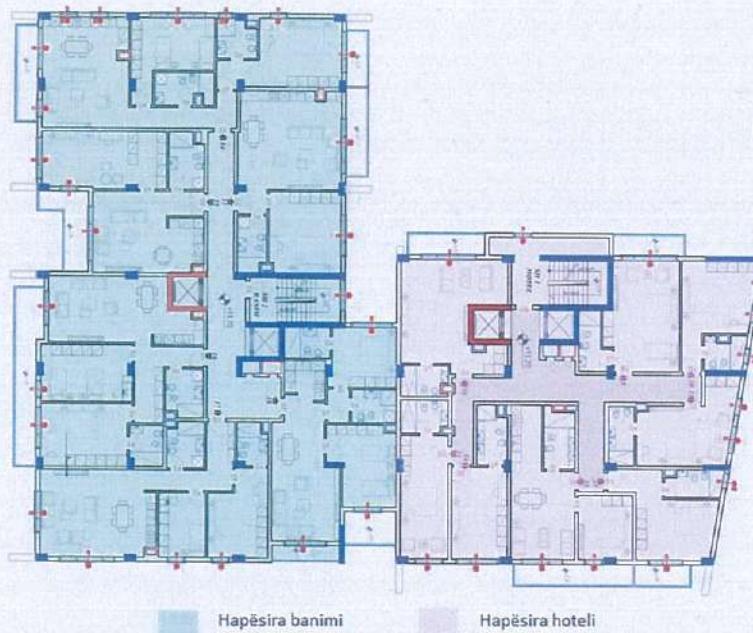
Ndarja e funksioneve brenda planimetrisë së katit tip
